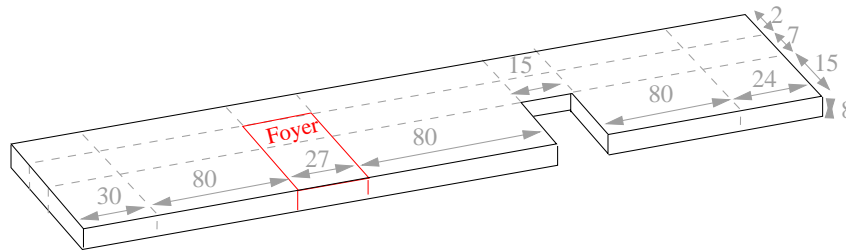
Description du maillage pour la dalle du faux-plafond.
